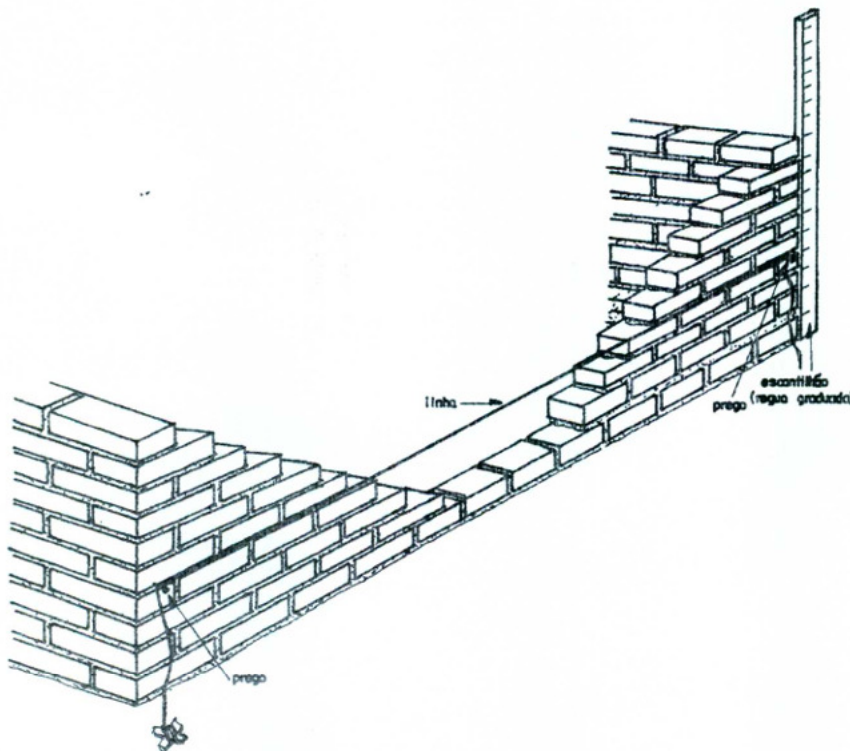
Detalhe do nivelamento da elevação da alvenaria.
